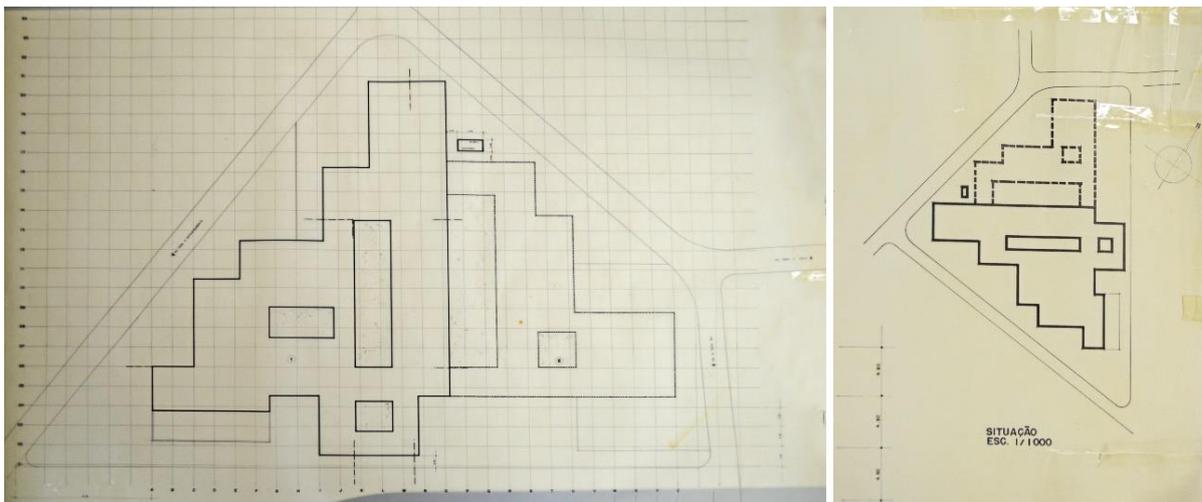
e 245: Planta de implantação e situação do estudo para a Creche, proposta de junho de 1982, destacando-se a proposição da construção em etapas, com o maior bloco destinado a Creche, tratado nesta análise, e outro destinado ao futuro pré-escolar e primeiro grau.
